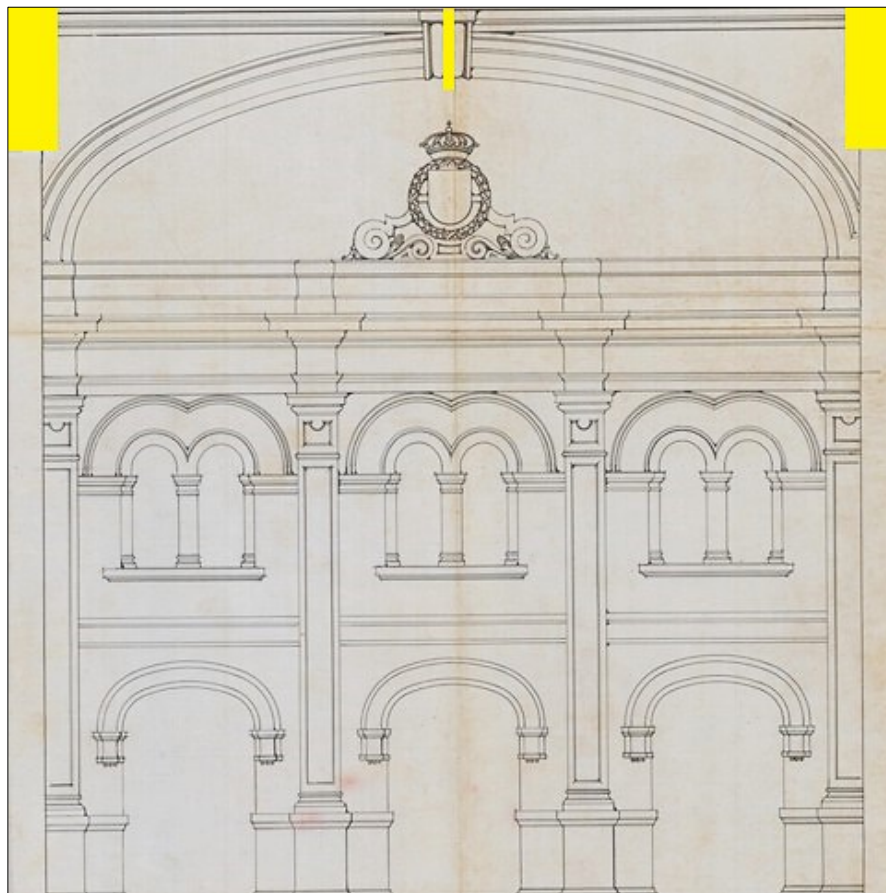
En la imagen aparecen resaltadas en amarillo las zonas de interferencia entre la decoración original proyectada por Ramírez de Dampierre y los elementos de hormigón armado o de hierro visibles en el interior.
